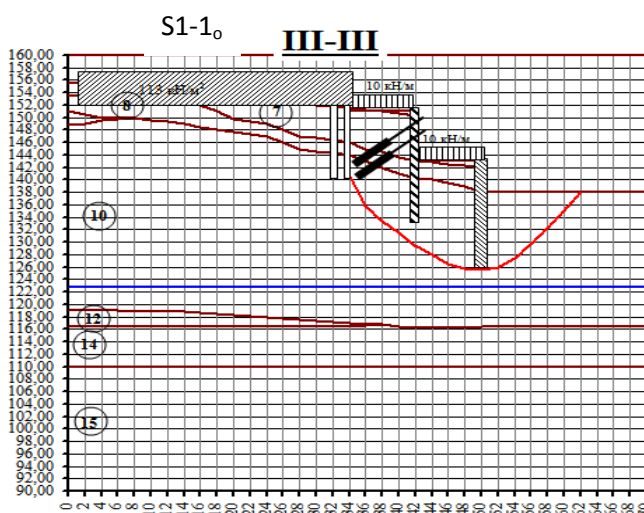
Расчетная схема устойчивости подпорных стен для сечения S1-1₀ с учетом работы анкеров
